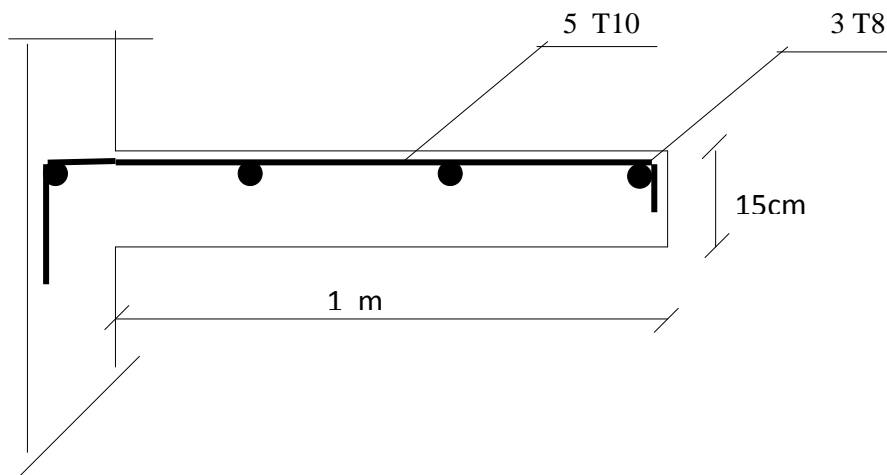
Schéma de ferrailage de Bbalcon
